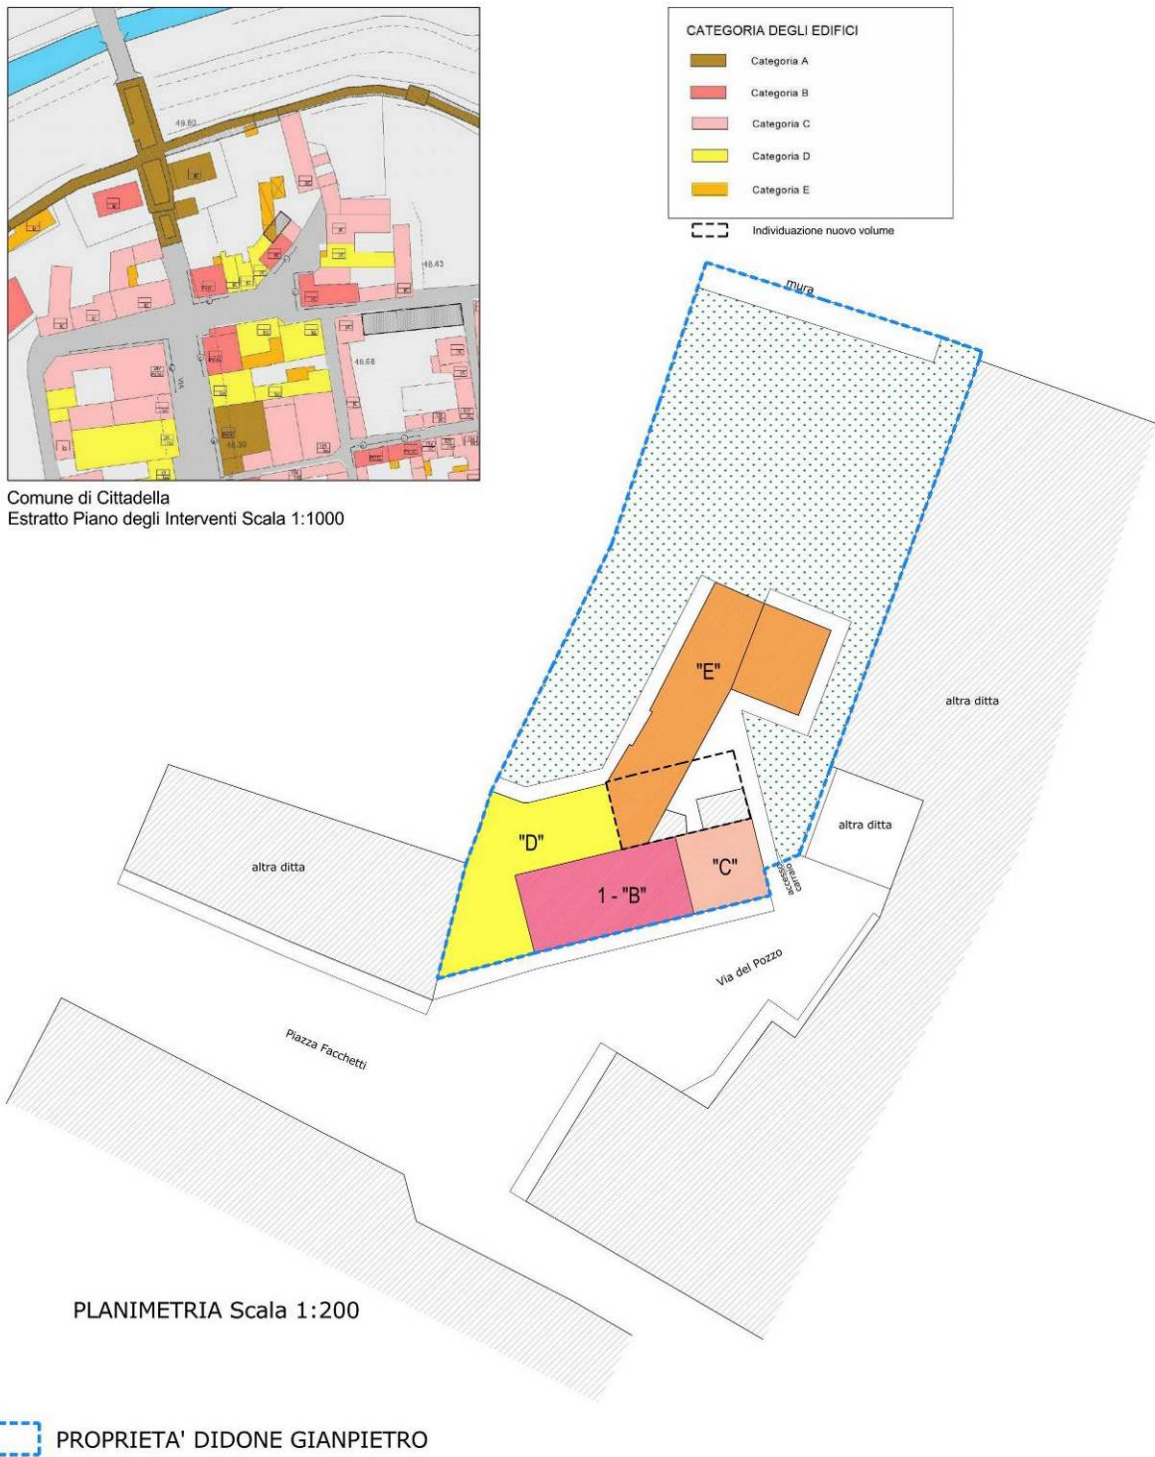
Planimetria dello stato di fatto dell'ambito oggetto di PdR
